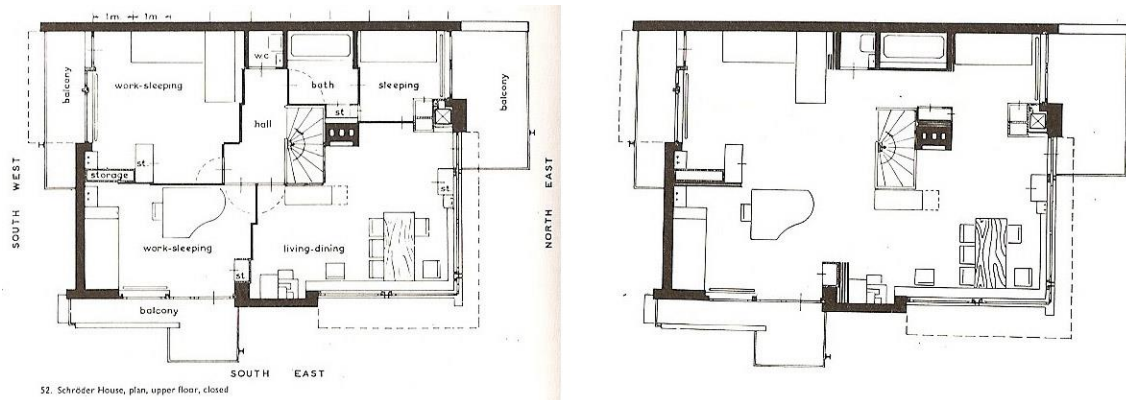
Planta de la casa Schröder, con los paneles correderos desplegados y sin desplegar. Fuente: (Frampton, 1987, p.148)
